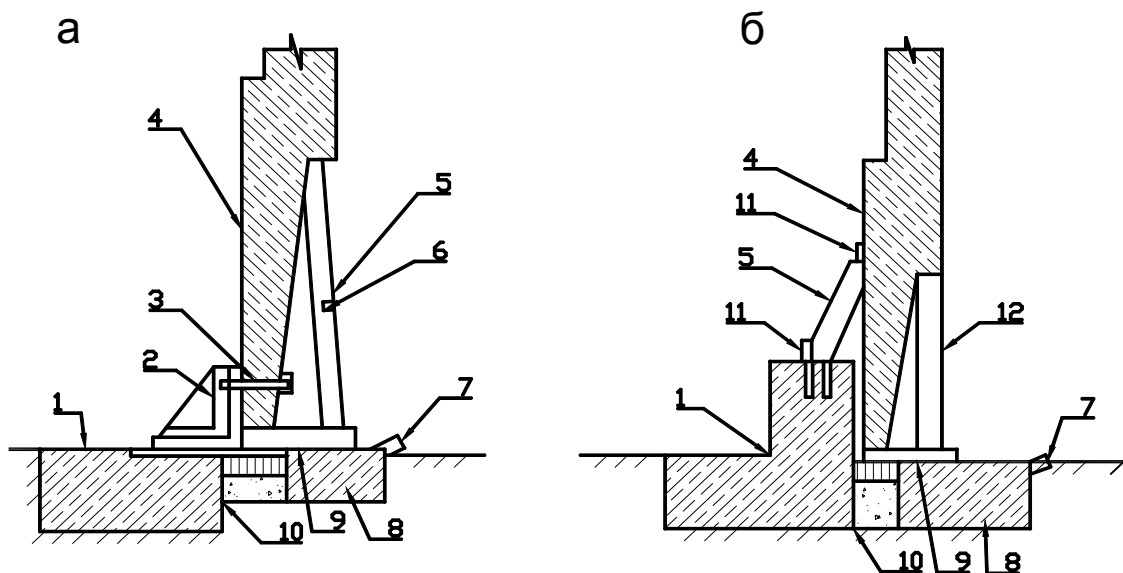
Тимчасові опорні конструкції збірних залізобетонних опускних колодязів:
